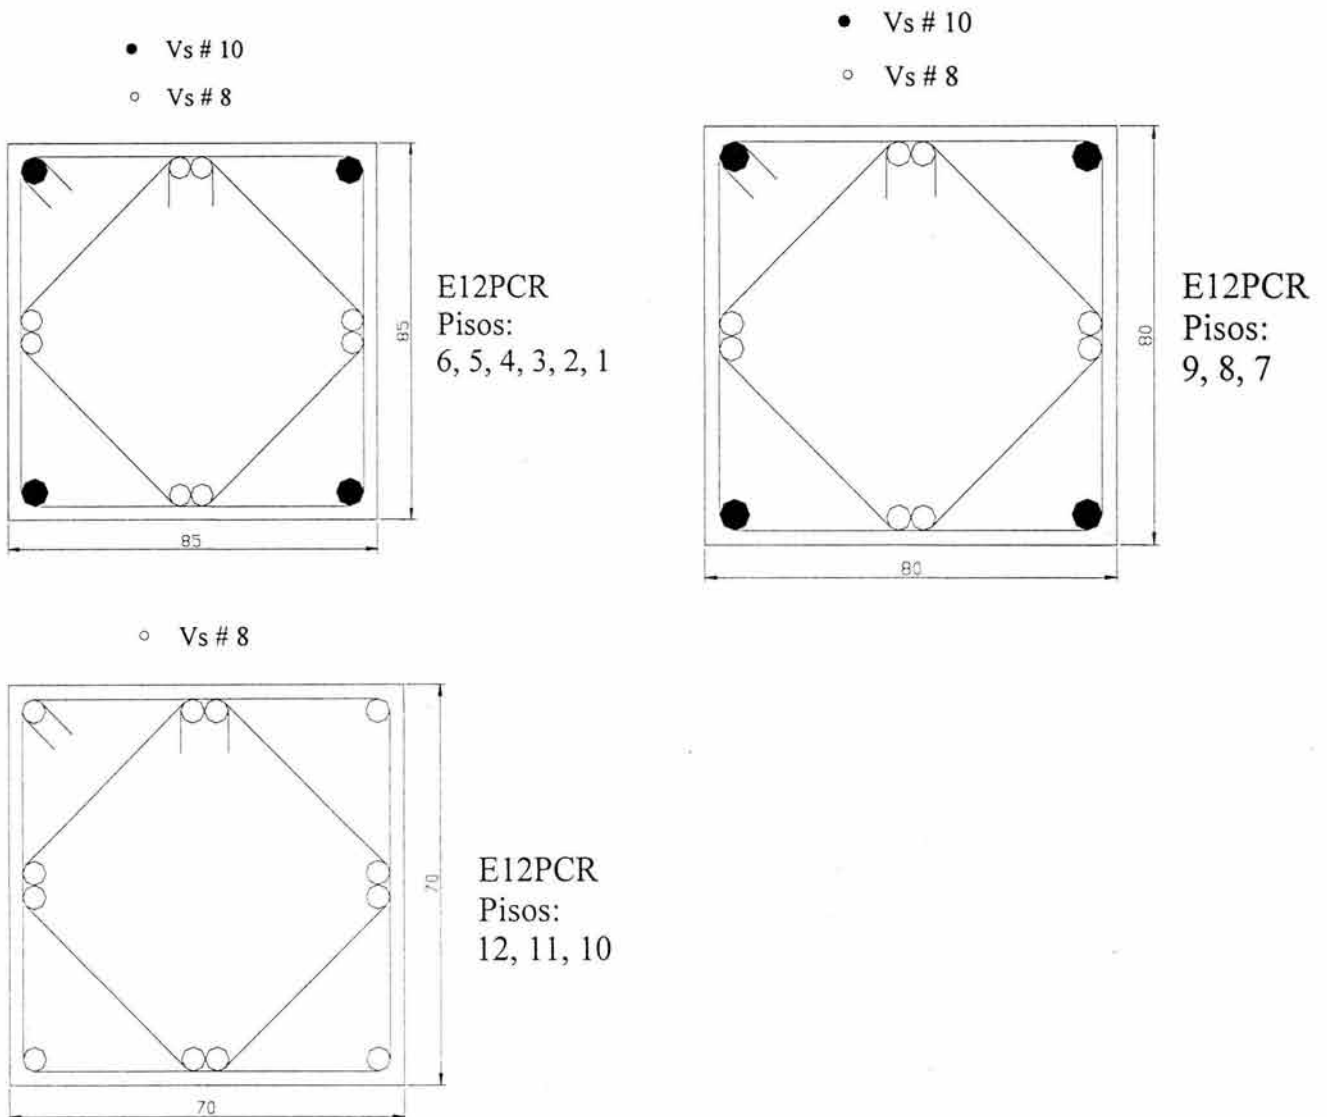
Detallado de columnas en edificio de 12 niveles, marcos exteriores.
